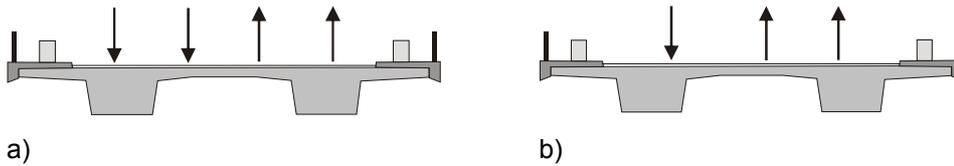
Beispiele für Brücken mit einteiligem Querschnitt (gemeinsamer Überbau für beide Richtungsfahrbahnen)
